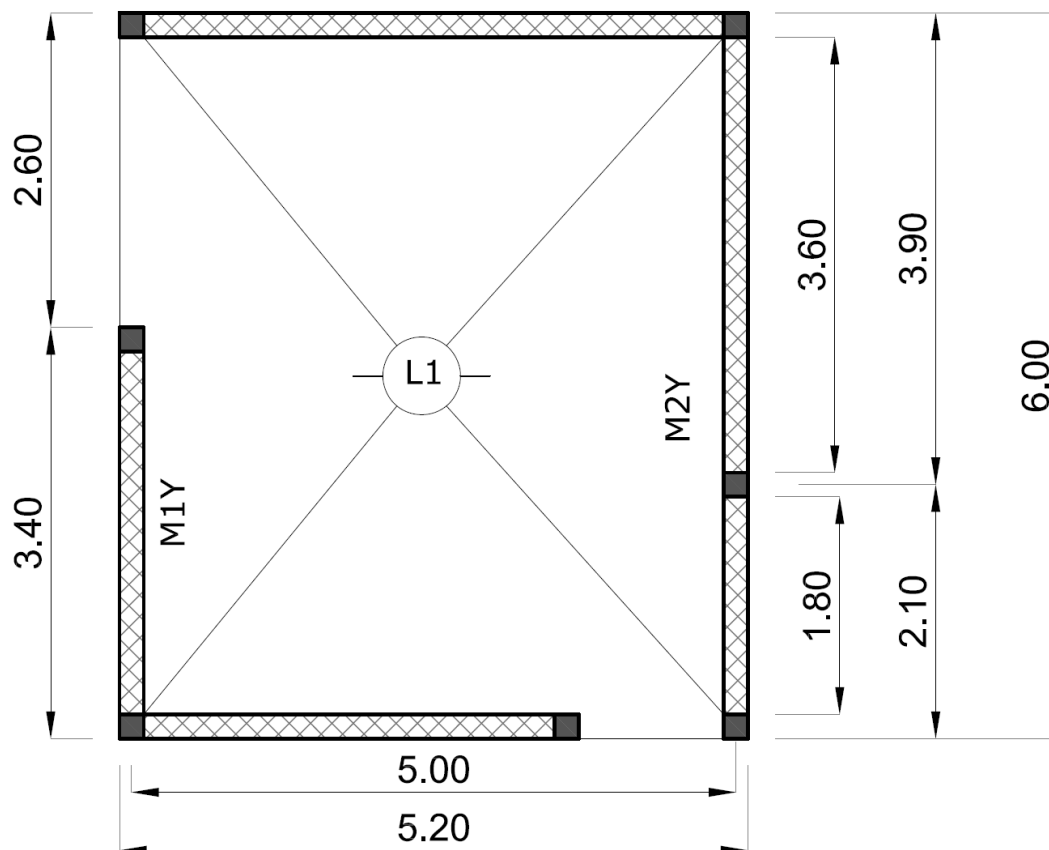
Planta de estructura. Altura piso 2.50m. Se estudiará el Muro 2Y
